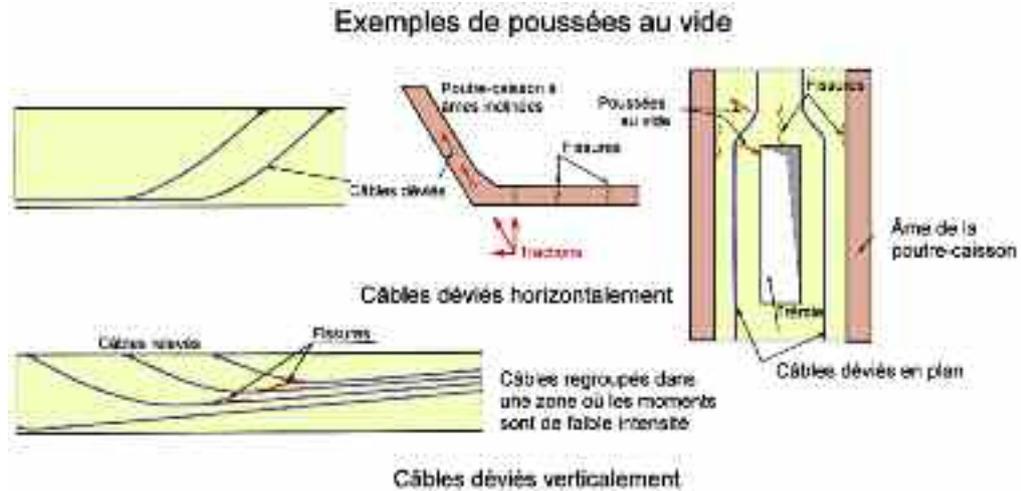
diverses poussées au vide engendrées par des déviations du tracé des armatures de précontrainte
